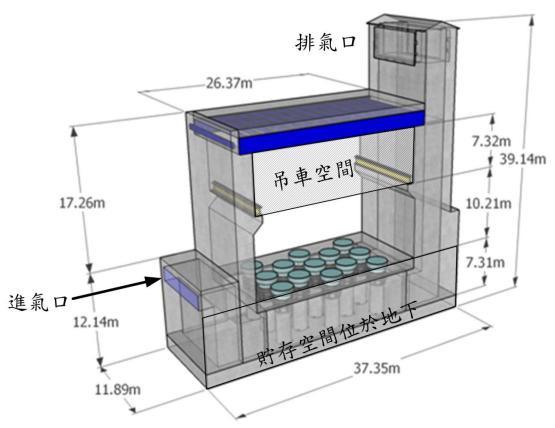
密封鋼筒混凝土貯存窖模組單元示意圖
